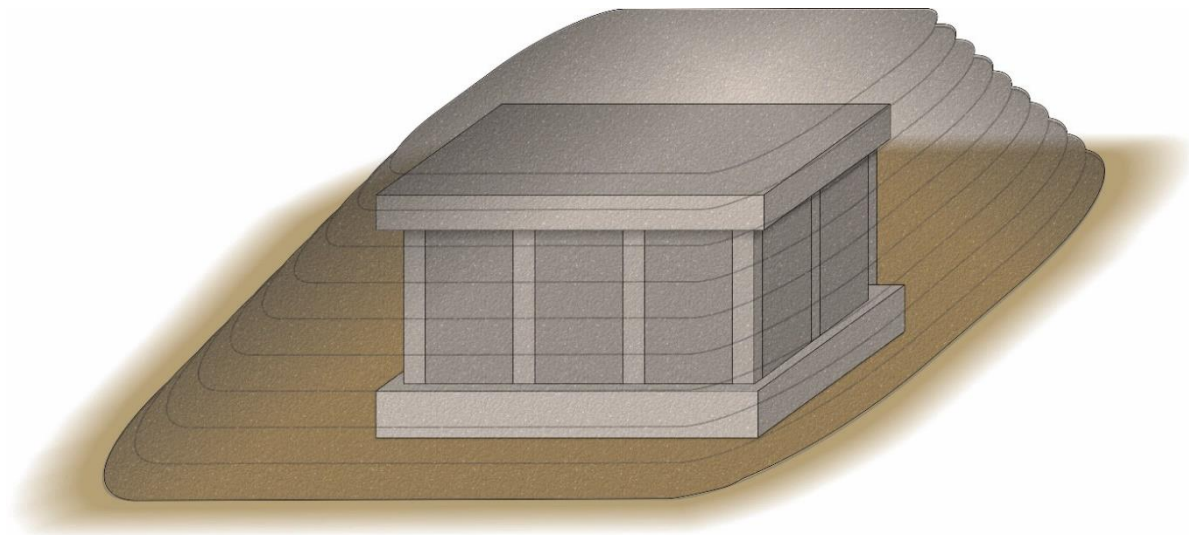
Oberflächennahe Einbettung des geschlossenen Endlagers ins Erdreich
